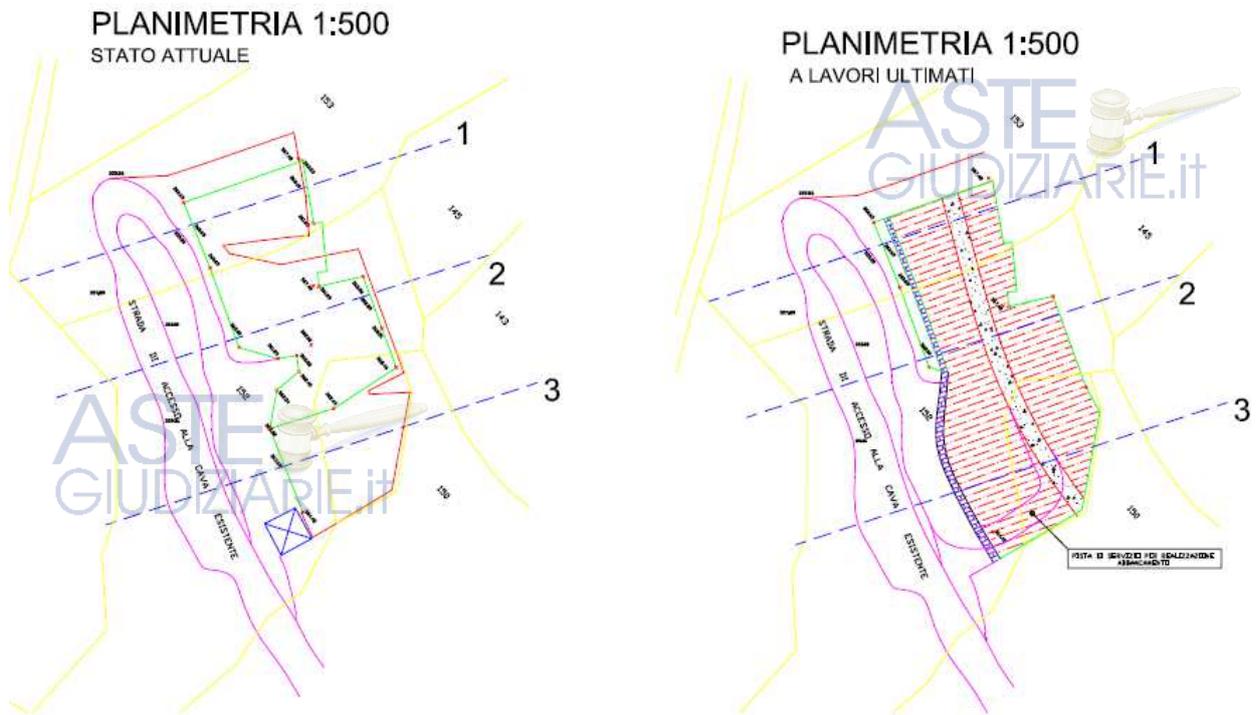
planimetria della fossa da riempire, stato attuale e definitivo
